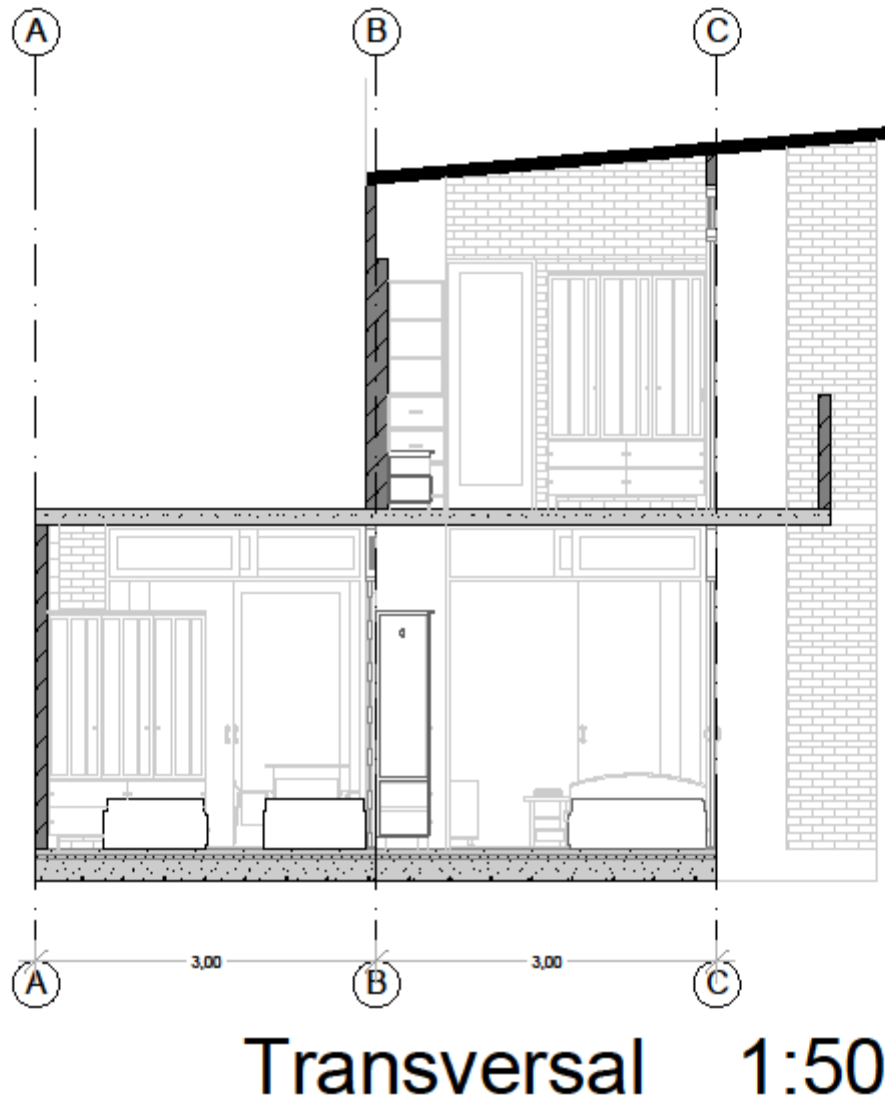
Tipo B. Corte C-4. Esc.: 1:50
